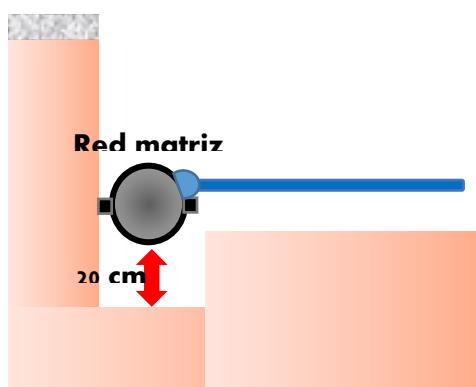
20 cm debajo del fondo de la tubería de distribución
